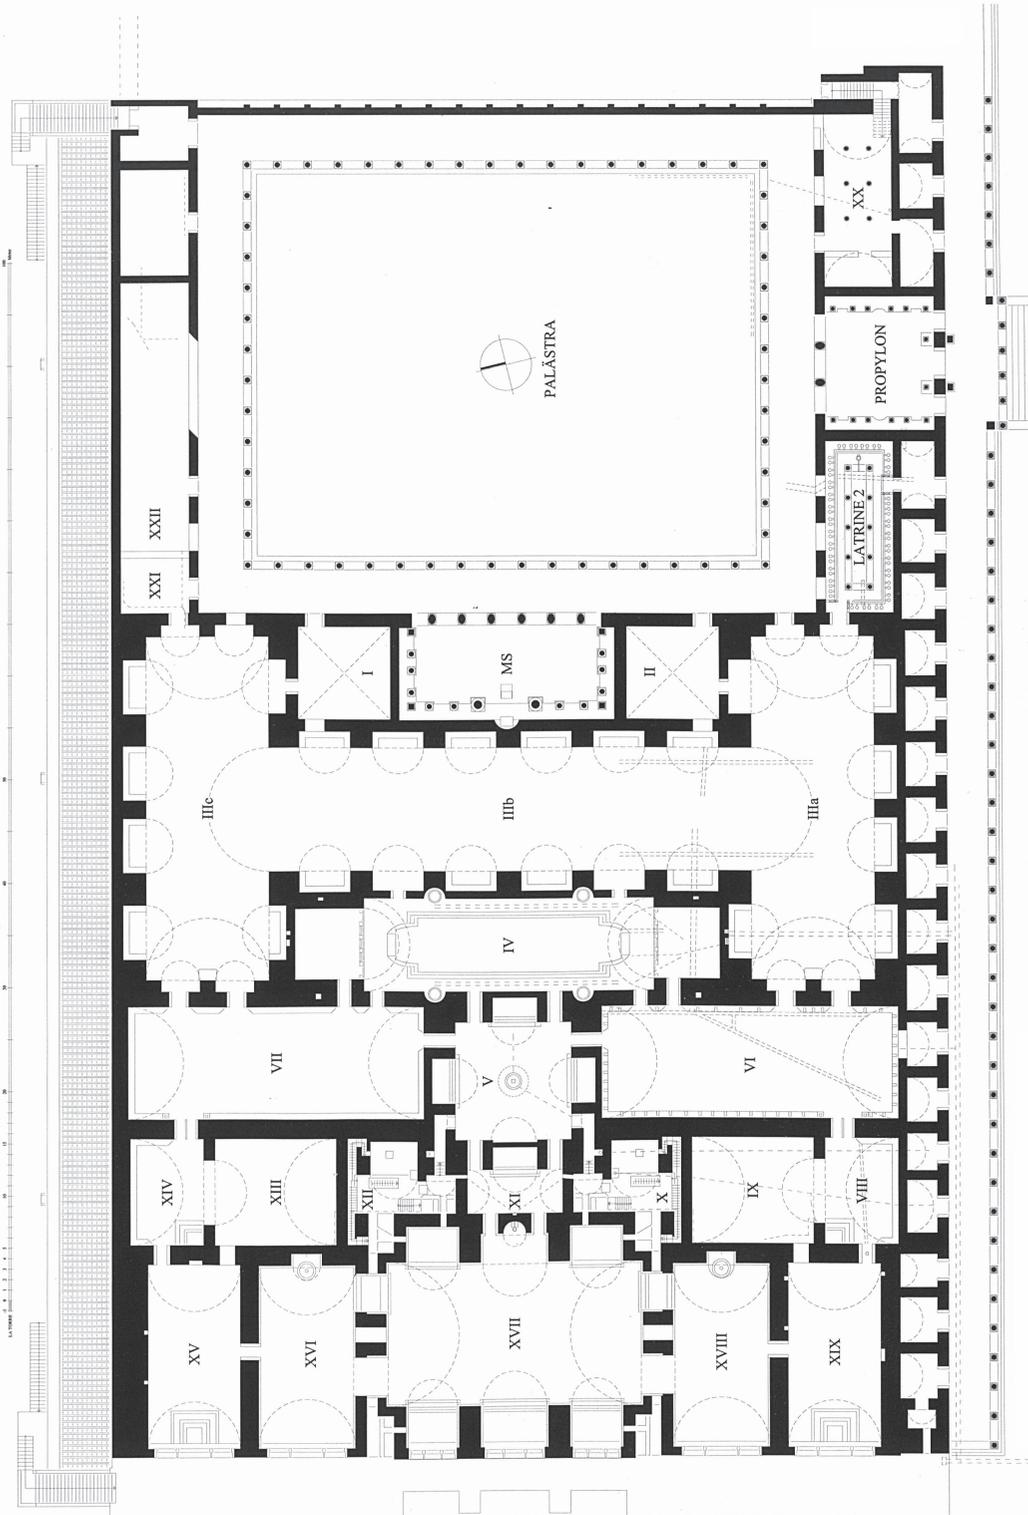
Rekonstruierter Grundrissplan des Vediusbads, Planzeichnung: M. La Torre, ÖAI-ÖAW
